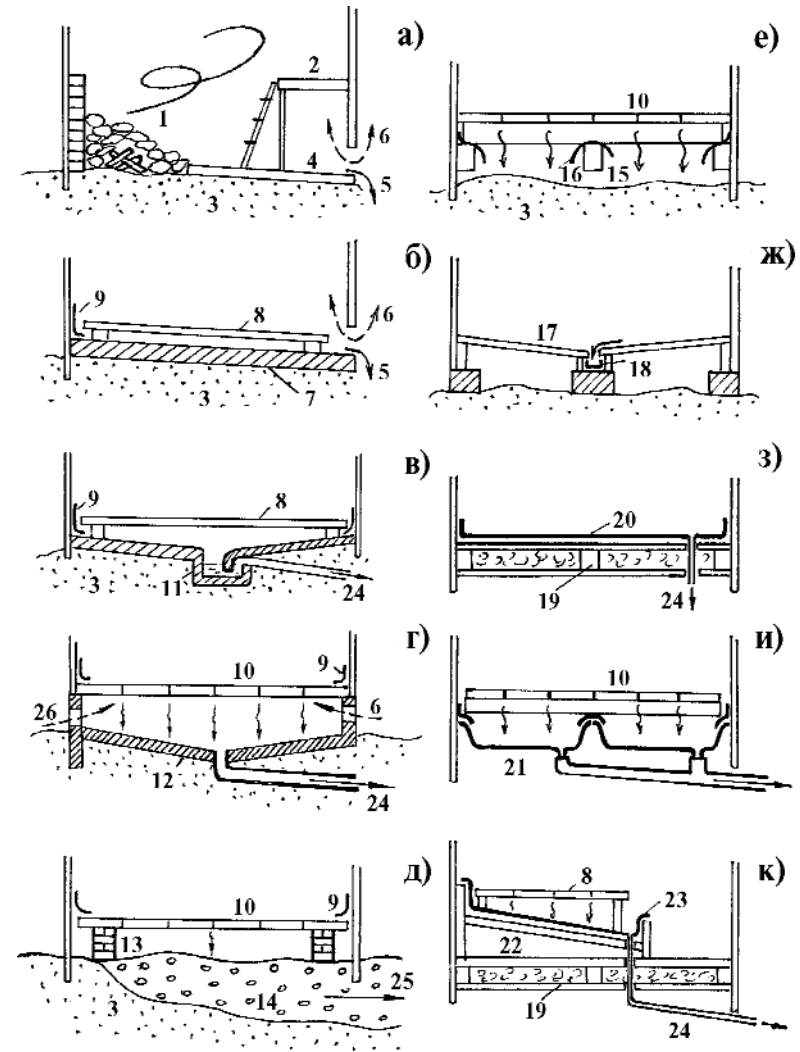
Принципиальные схемы банных полов (приведены без привязки к стенам и фундаментам): а – дощатый настил по земляному (глиняному) полу, б – дощатый настил по бетонному полу, в – бетонный профилированный пол со сливом воды в трап, г – дощатый протекающий пол со сливом воды в бетонную вентилируемую воронку, д – дощатый протекающий пол со сливом
